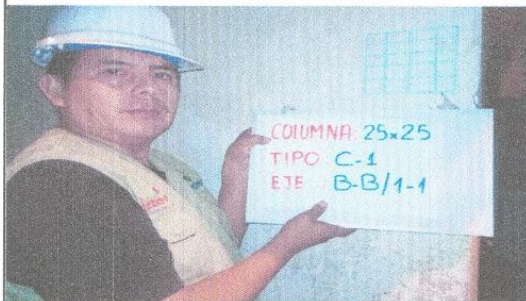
Columna ubicado en el 1er piso Eje B-B/1-1
